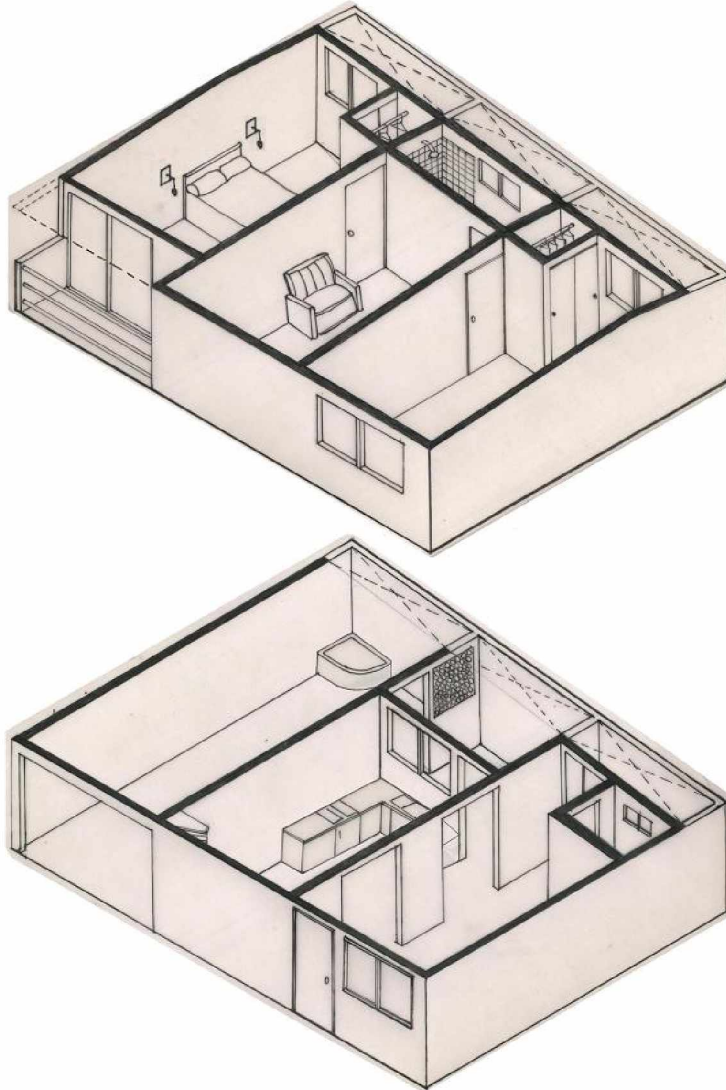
BOCETO ISOMÉTRICO DE PLANTA ALTA Y PLANTA BAJA
